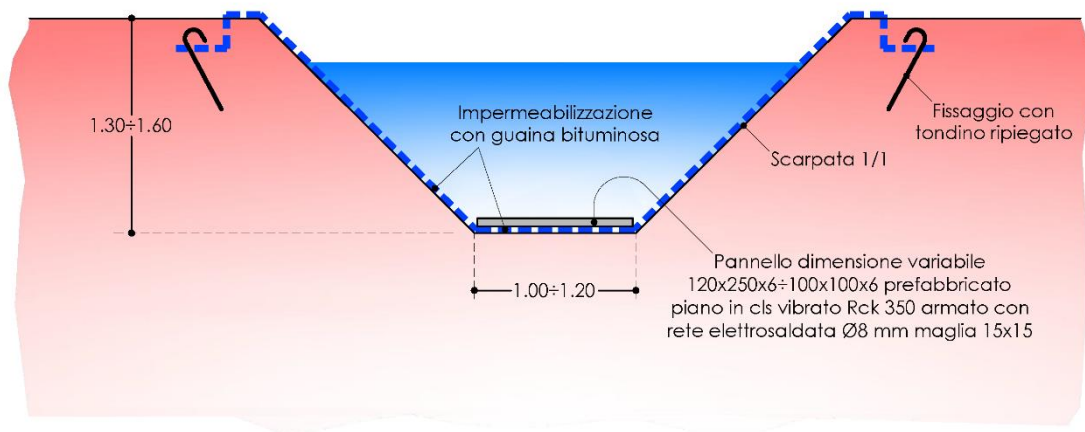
Adduttori. Impermeabilizzazione con guaina e piastra in c.a..
